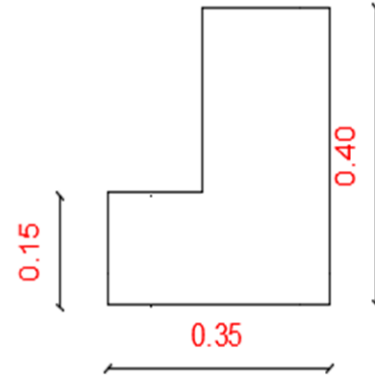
Vigas prefabricados con dimensiones. Fuente: Prefabricados Teide
